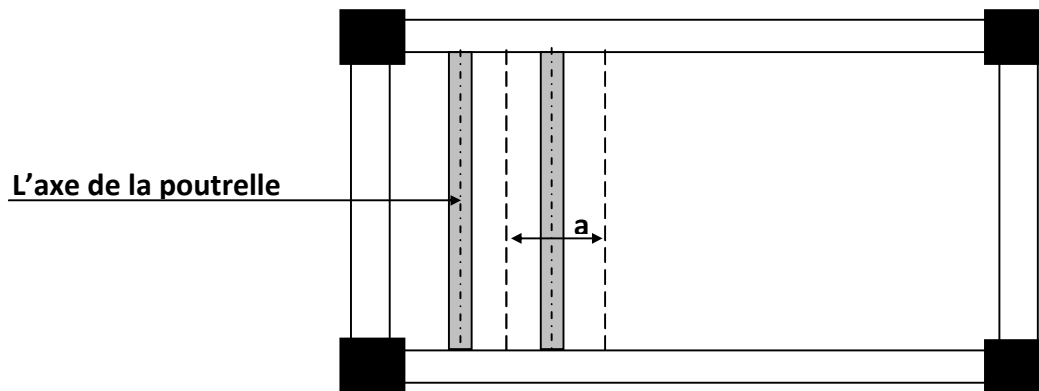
Plancher avec poutrelles pré fabriquées.
